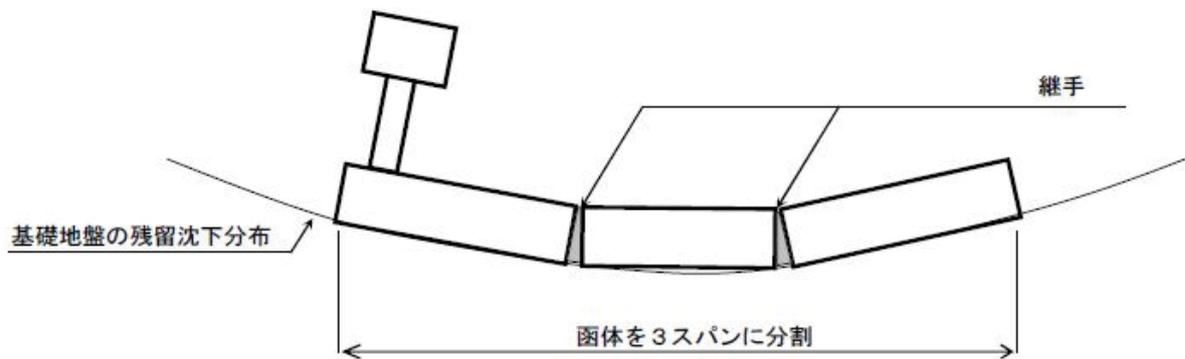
基礎地盤の残留沈下分布と函体のスパン割概念図
